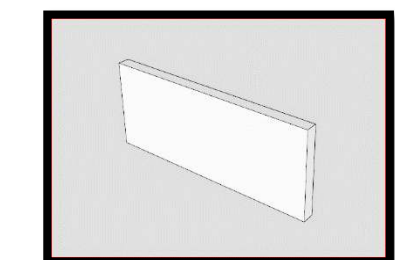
photo représente un mur de contreventement centrale,Src :auteur
